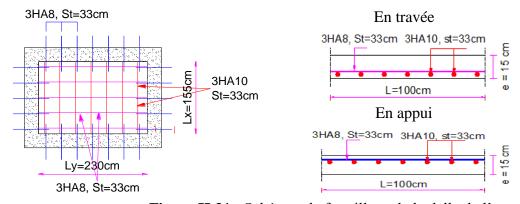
Schémas de ferraillage de la dalle de l'ascenseur
